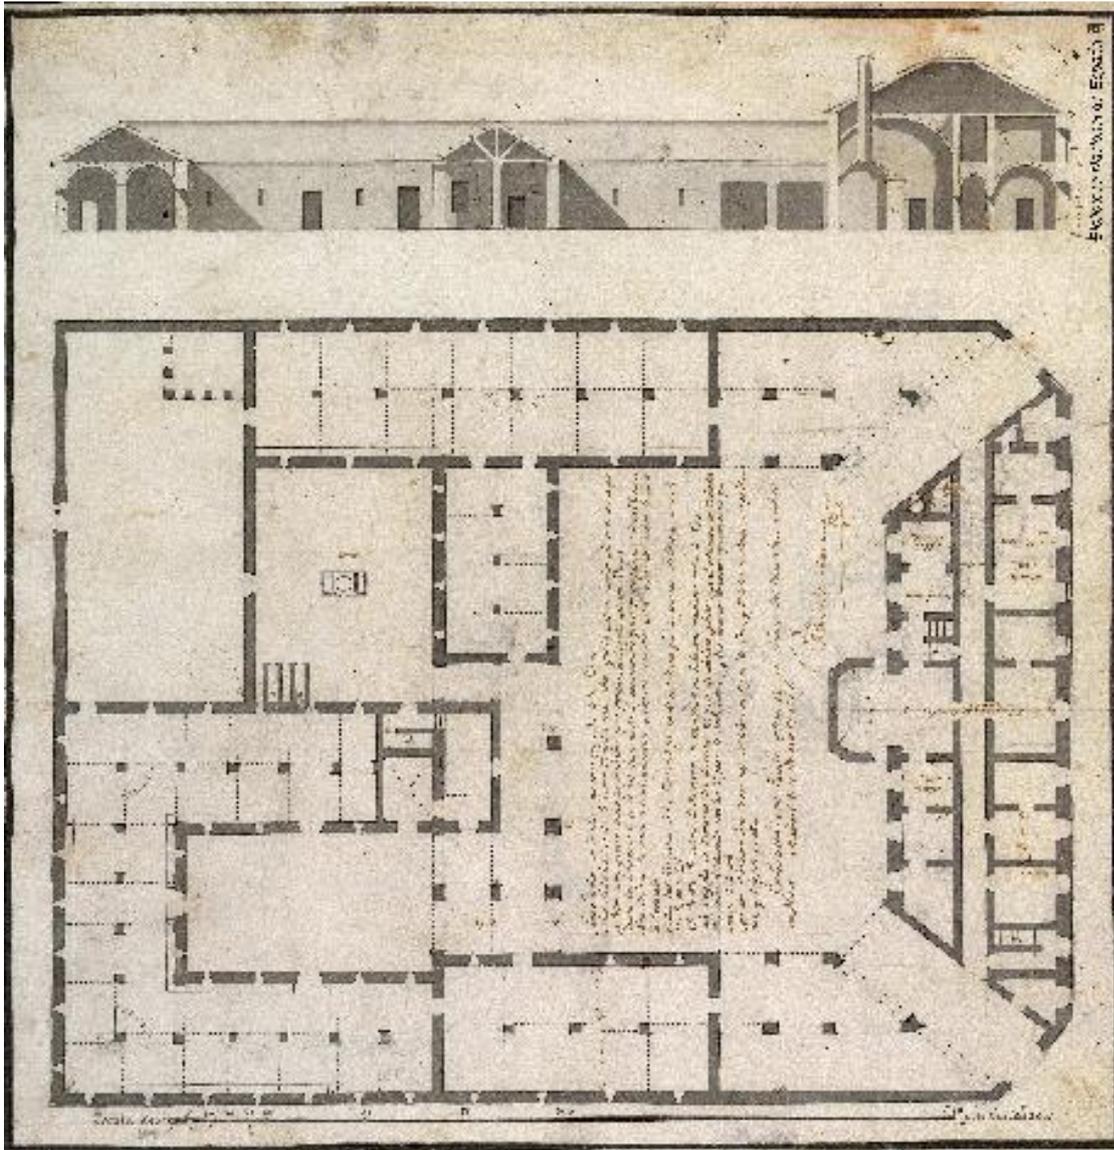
Planta y sección de almacén con vivienda²⁴
